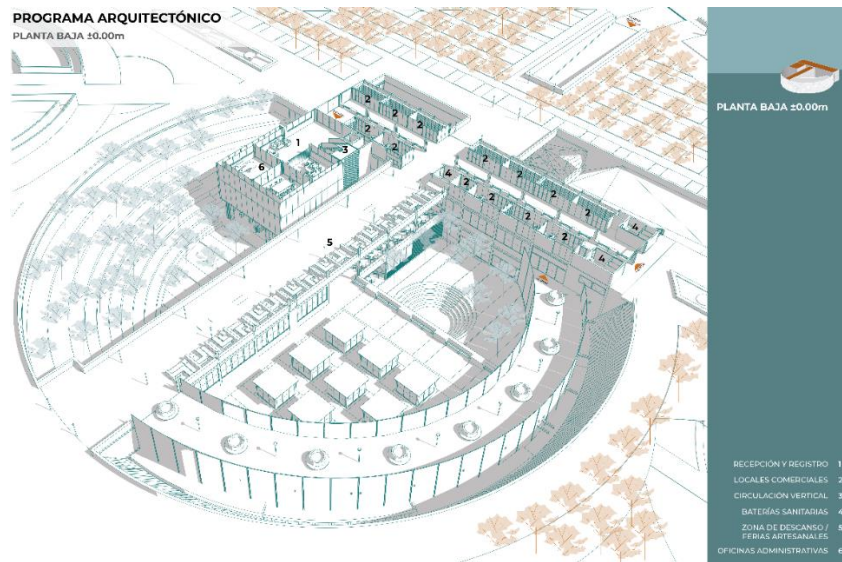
Programa Arquitectónico Planta Baja ±0.00m (Abad, D. 2021)
